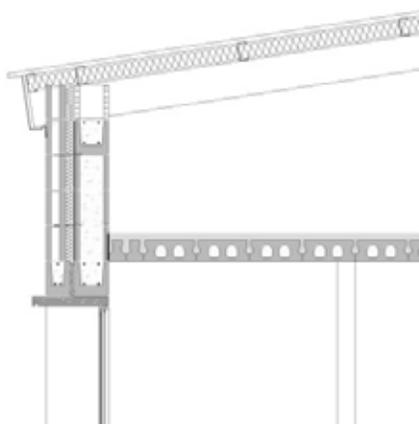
Proyecto de Unidad Campus Corte Tipo. Fuente: Elaboración propia. Año 2018.
